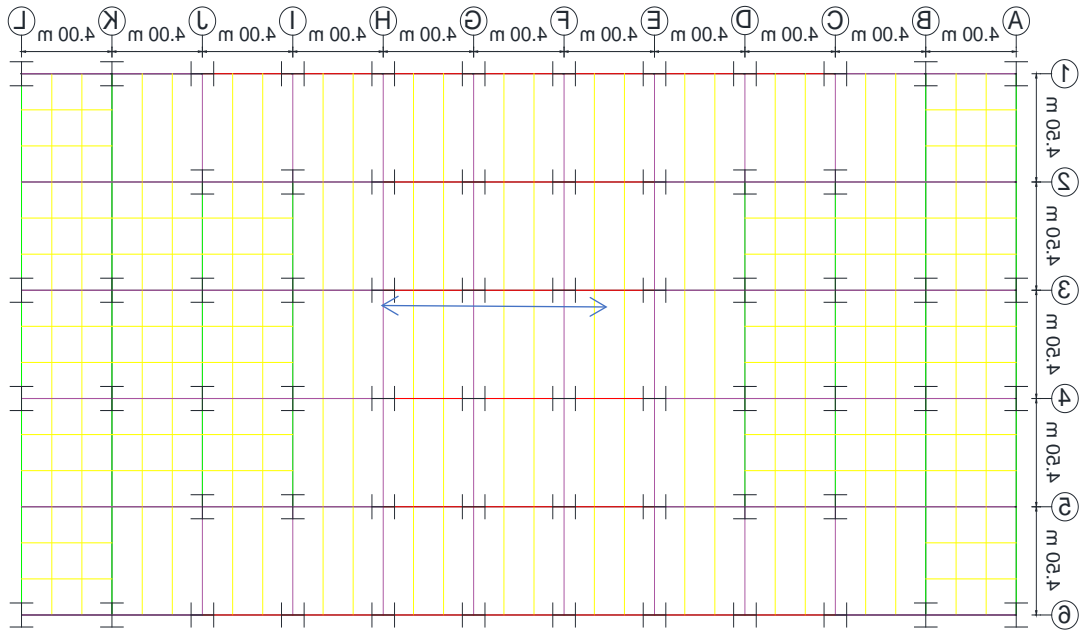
Planta de techo de la edificación híbrida con panel Vierendeel 2m.
